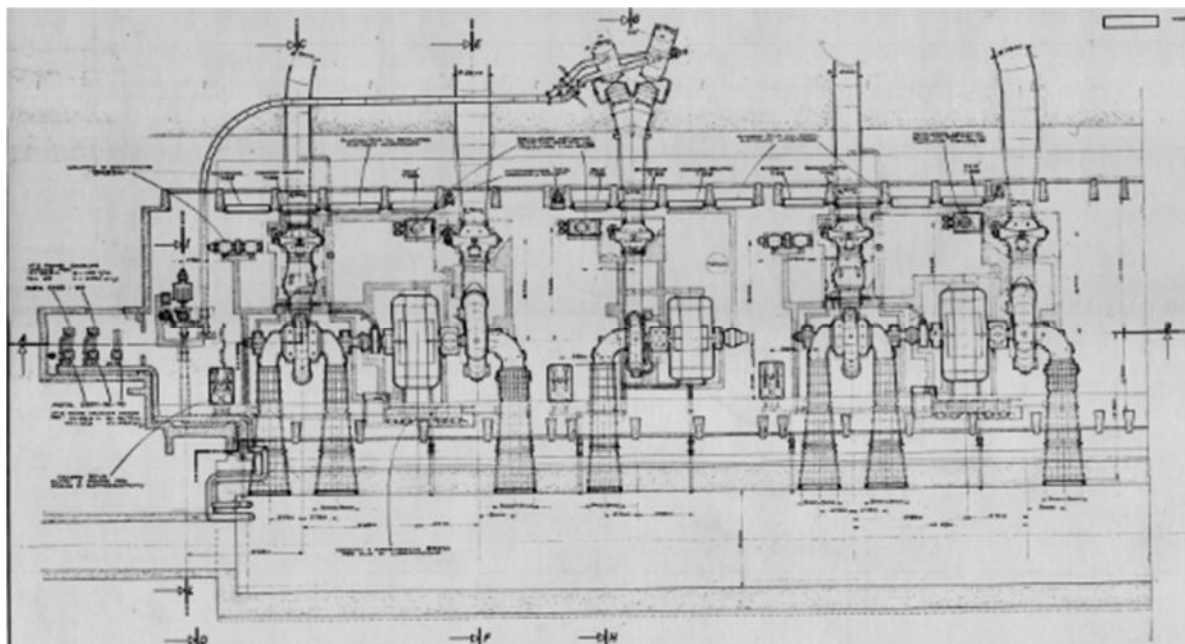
Edificio centrale – Planimetria. Piano Nr. 128700, agosto 1960
